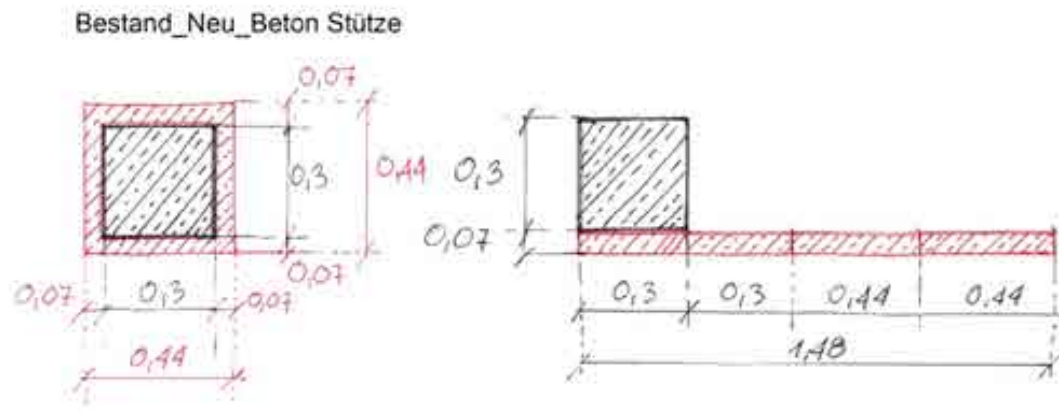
Stütze mit Abwicklung, Bestand und Neu Stahlbeton
